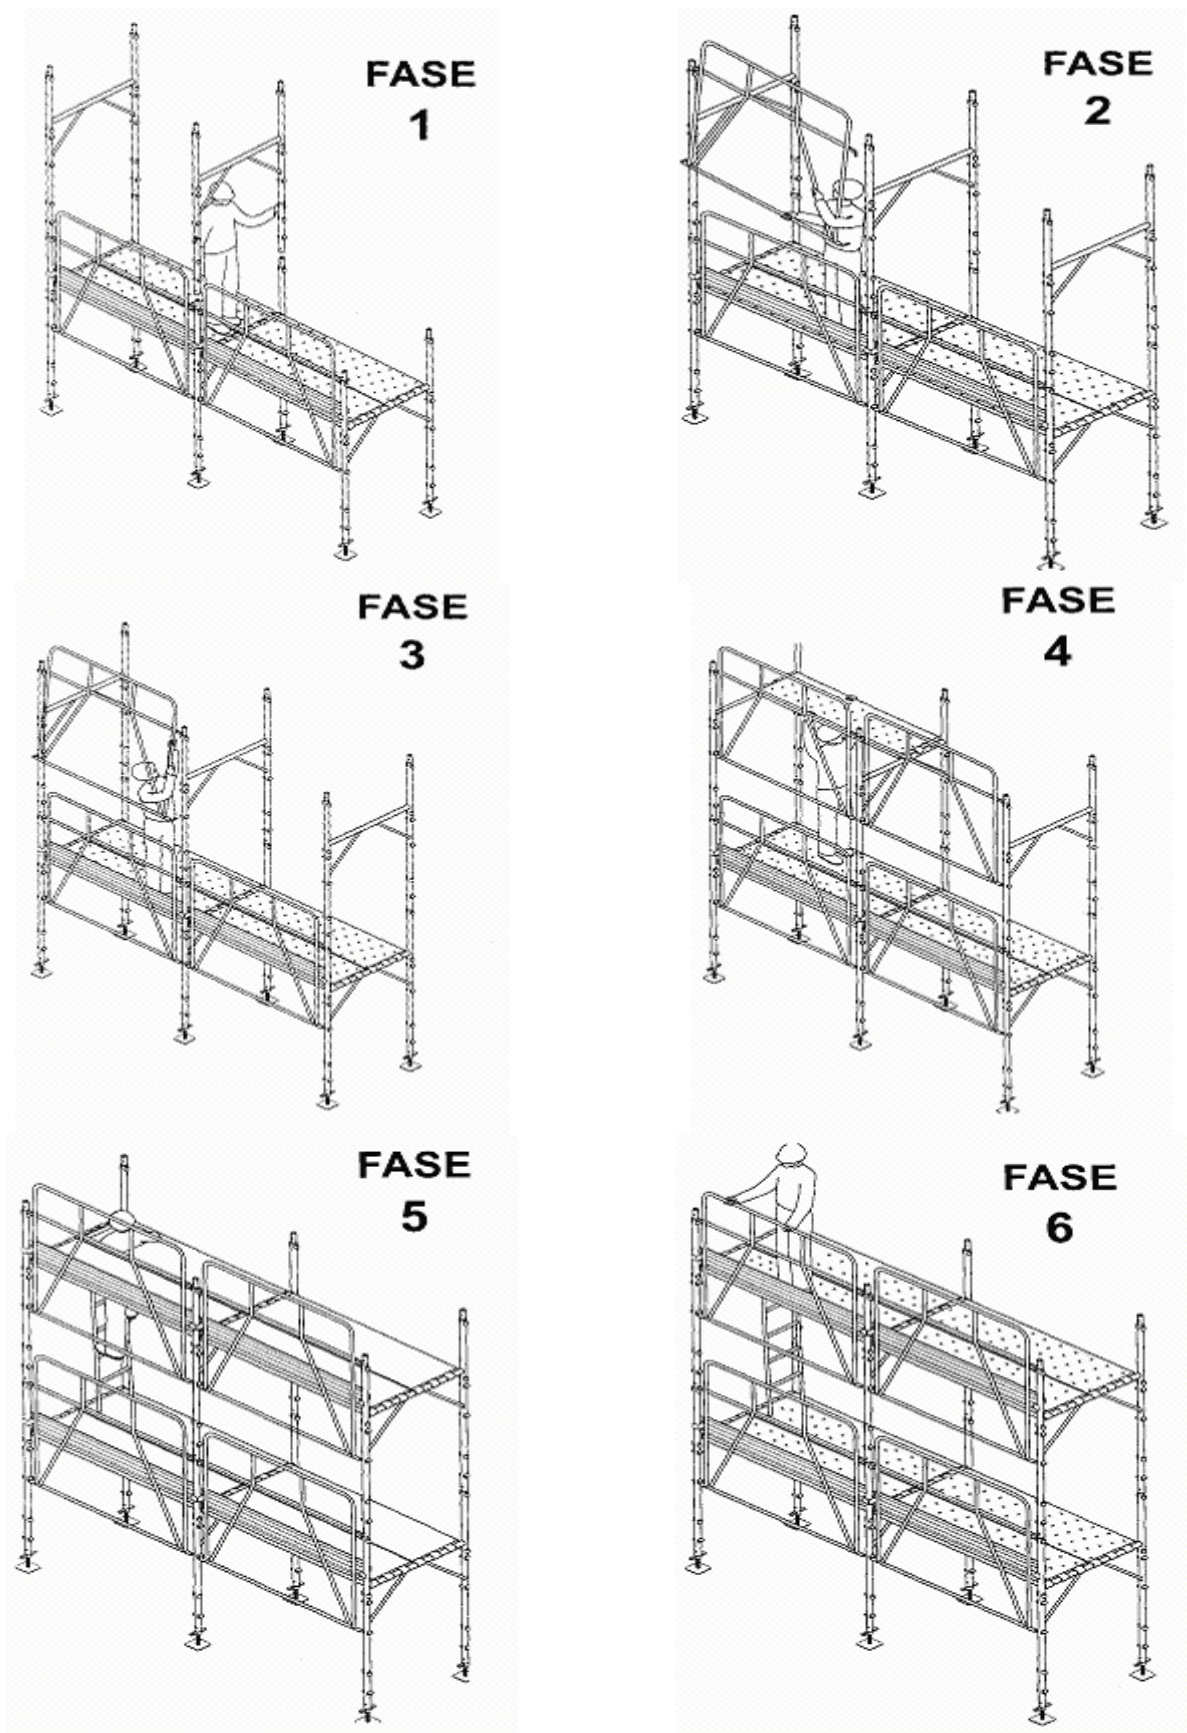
Fasi di montaggio dal basso del ponteggio con parapetto di protezione collettivo
